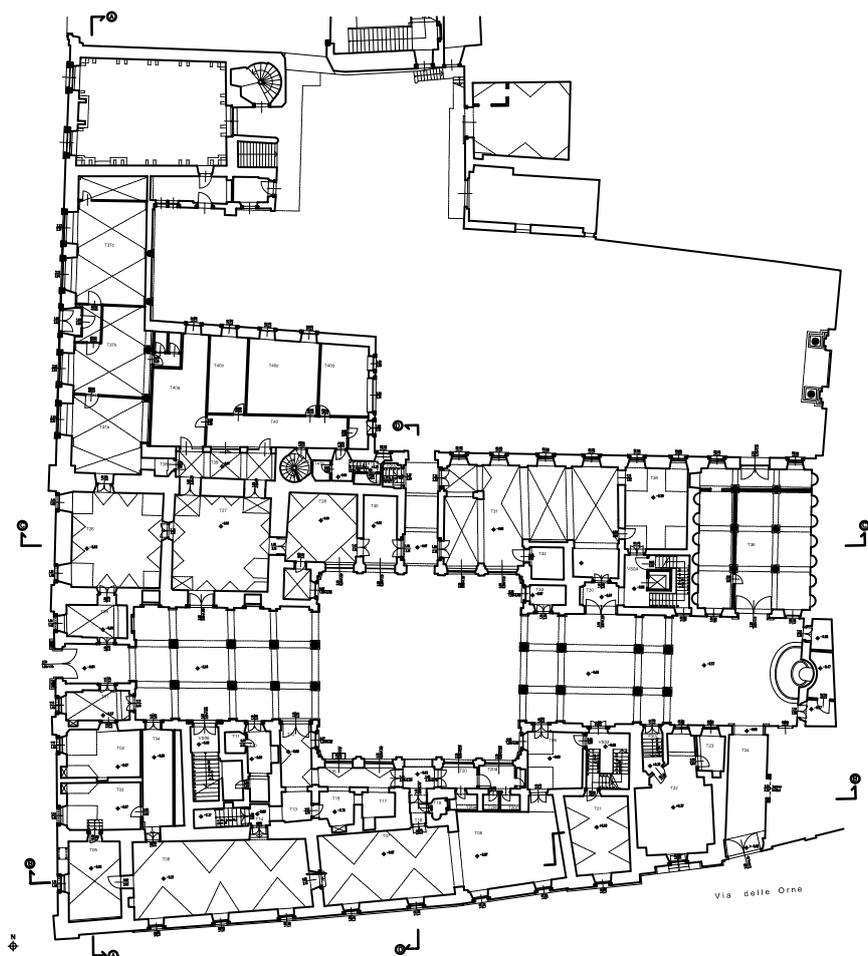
Palazzo Thun: rilievo del piano terra precedente al progetto di restauro.
